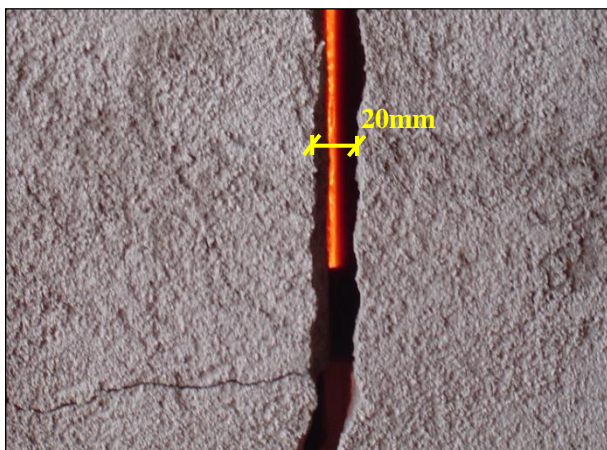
Detalhe da principal fissura ocorrida na parede com revestimento e com preenchimento.
